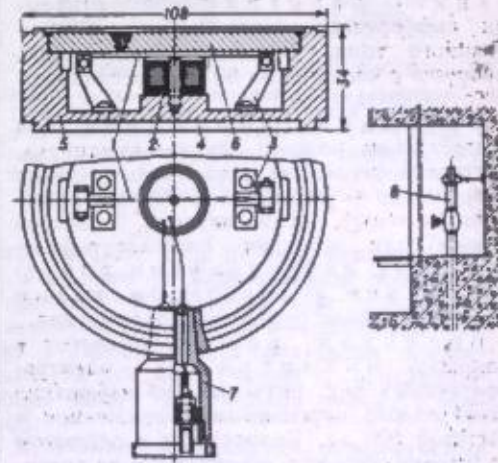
Датчик напорного пьезометра и схема установки пьезометра: 1 — измерительная струна; 2 — катушка электромагнита; 3 — контакты; 4 — кольцевая мембрана; 5 — корпус; 6 — крышка; 7 — токоведущий штуцер; 8 — пьезометр.
